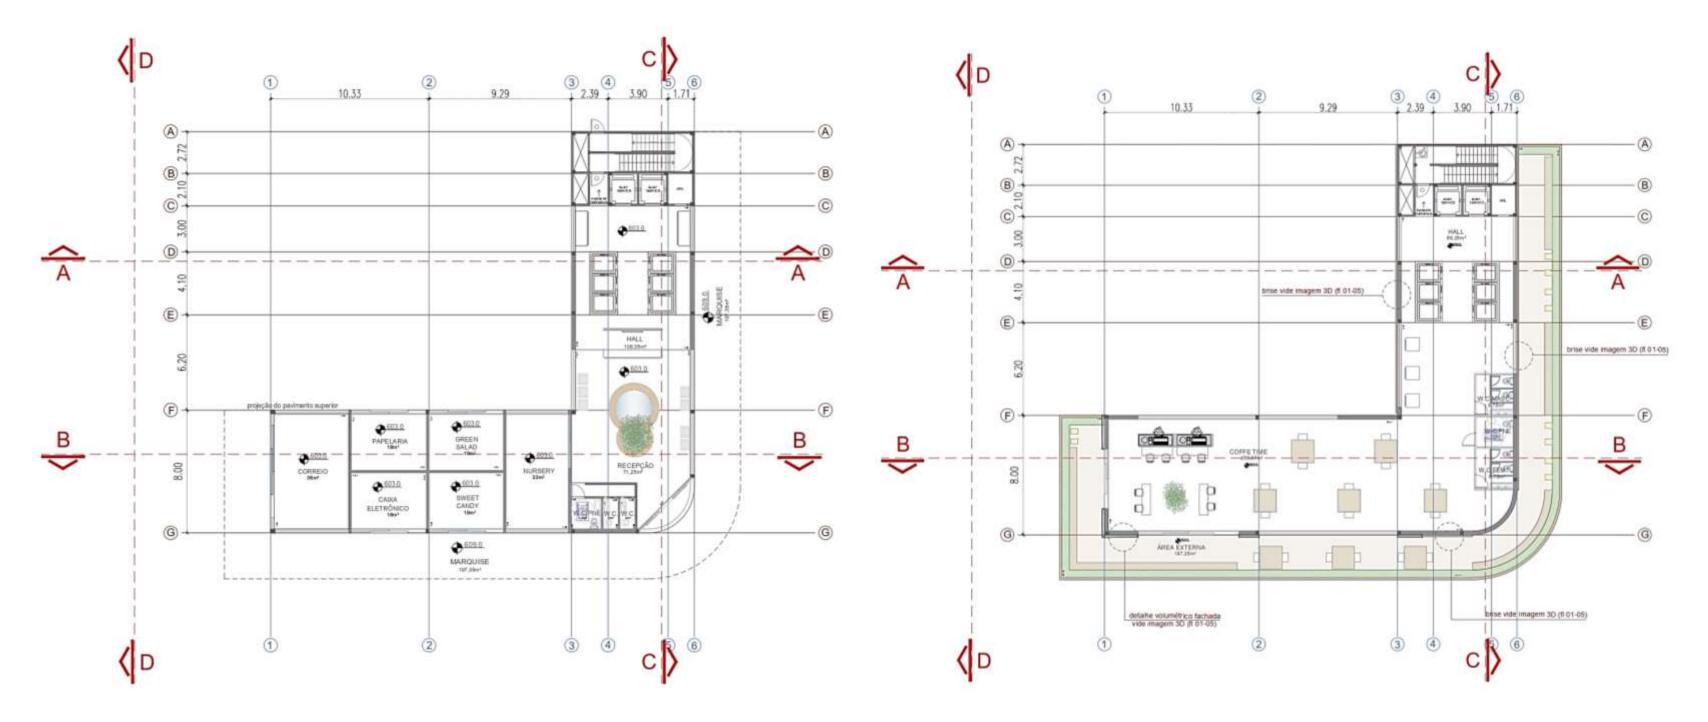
Planta Tipo do 2° ao 5° Pavimentos e do Planta do 6° Pavimento
